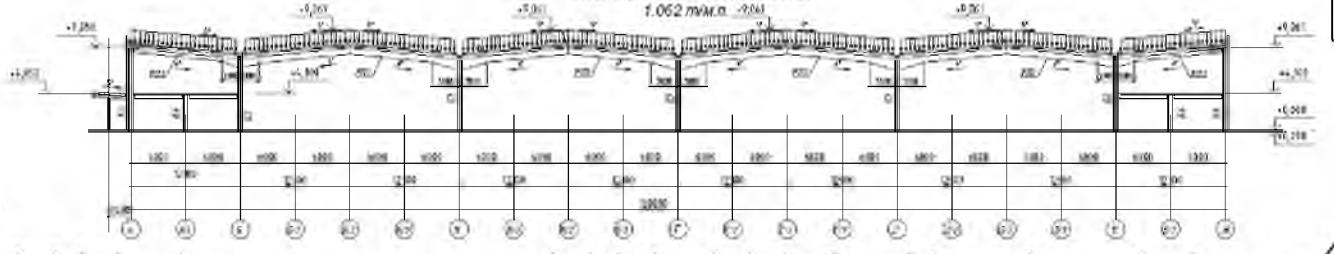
Снігове навантаження на будки покриття симетричне навантаження
